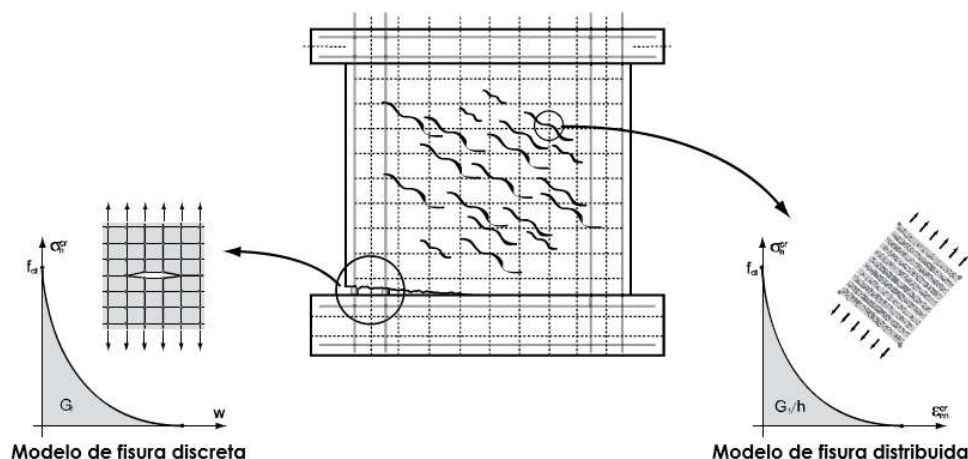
Modelos de fisura en hormigón (midasFEA, 2015)
